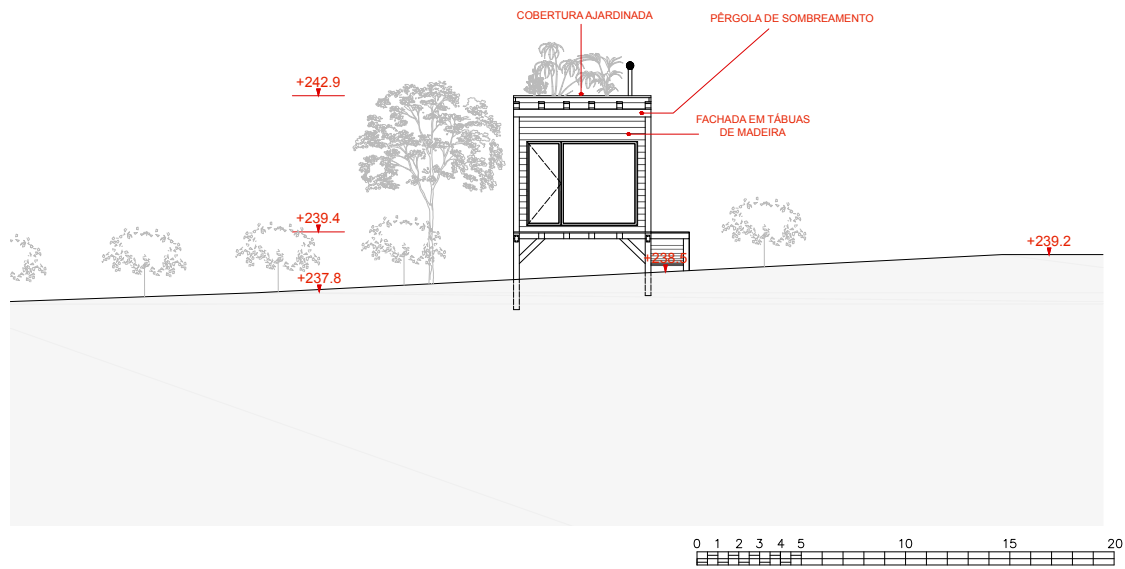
Alçado Norte do Alojamento Proposto Esc.1:50
